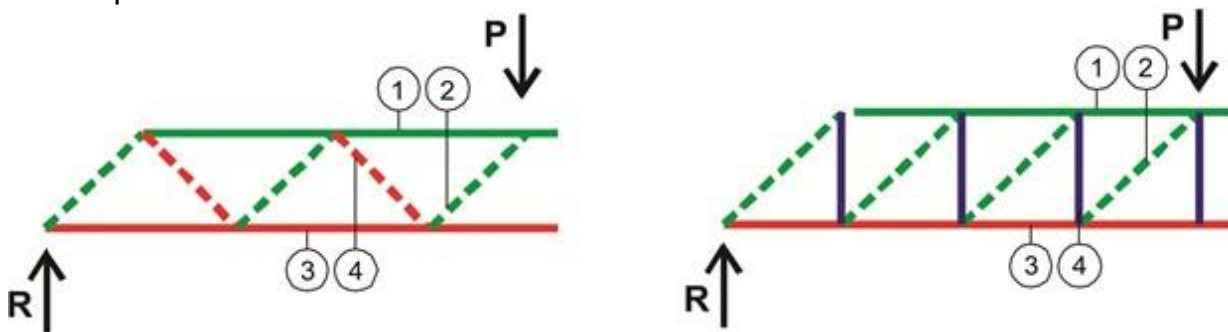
Mecanismo de transmisión de esfuerzo de corte análogo a reticulado.
